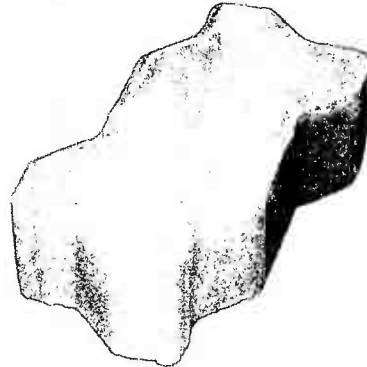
Bloco de pavimentação intertravado 16 faces
